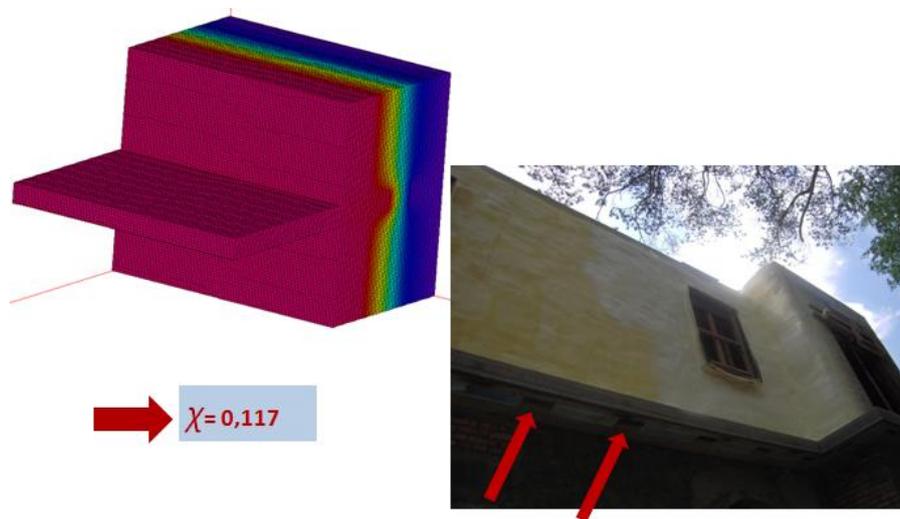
Примыкание ж/б консоли к наружной стене через несущий теплоизоляционный элемент в зоне межэтажного перекрытия.
